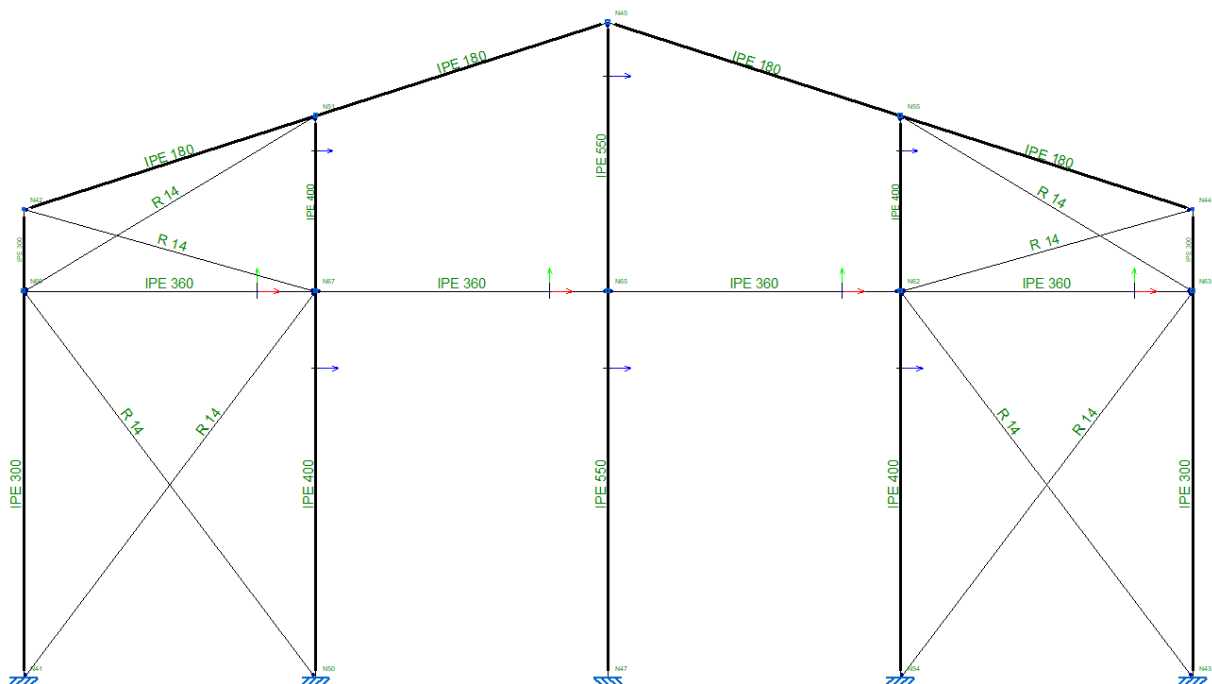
Pórtico de fachada tipo (caso particular mostrado IPE).
